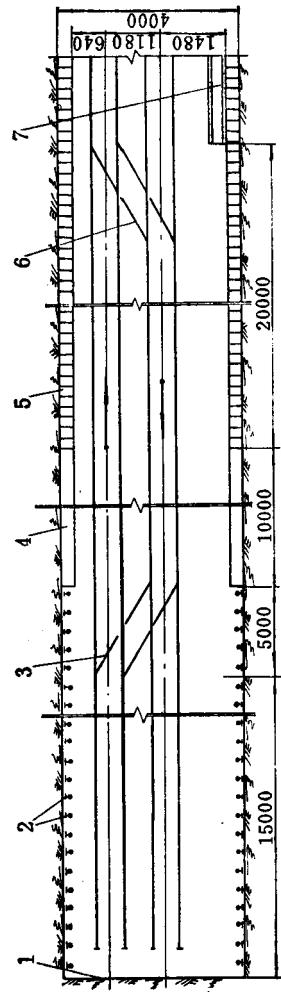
1 徐州韩桥双轨运输大巷施工平面布置示意图
